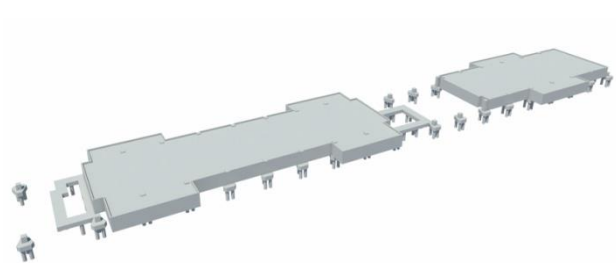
Fundación pilotes y zapata corrida para tabique de contención
